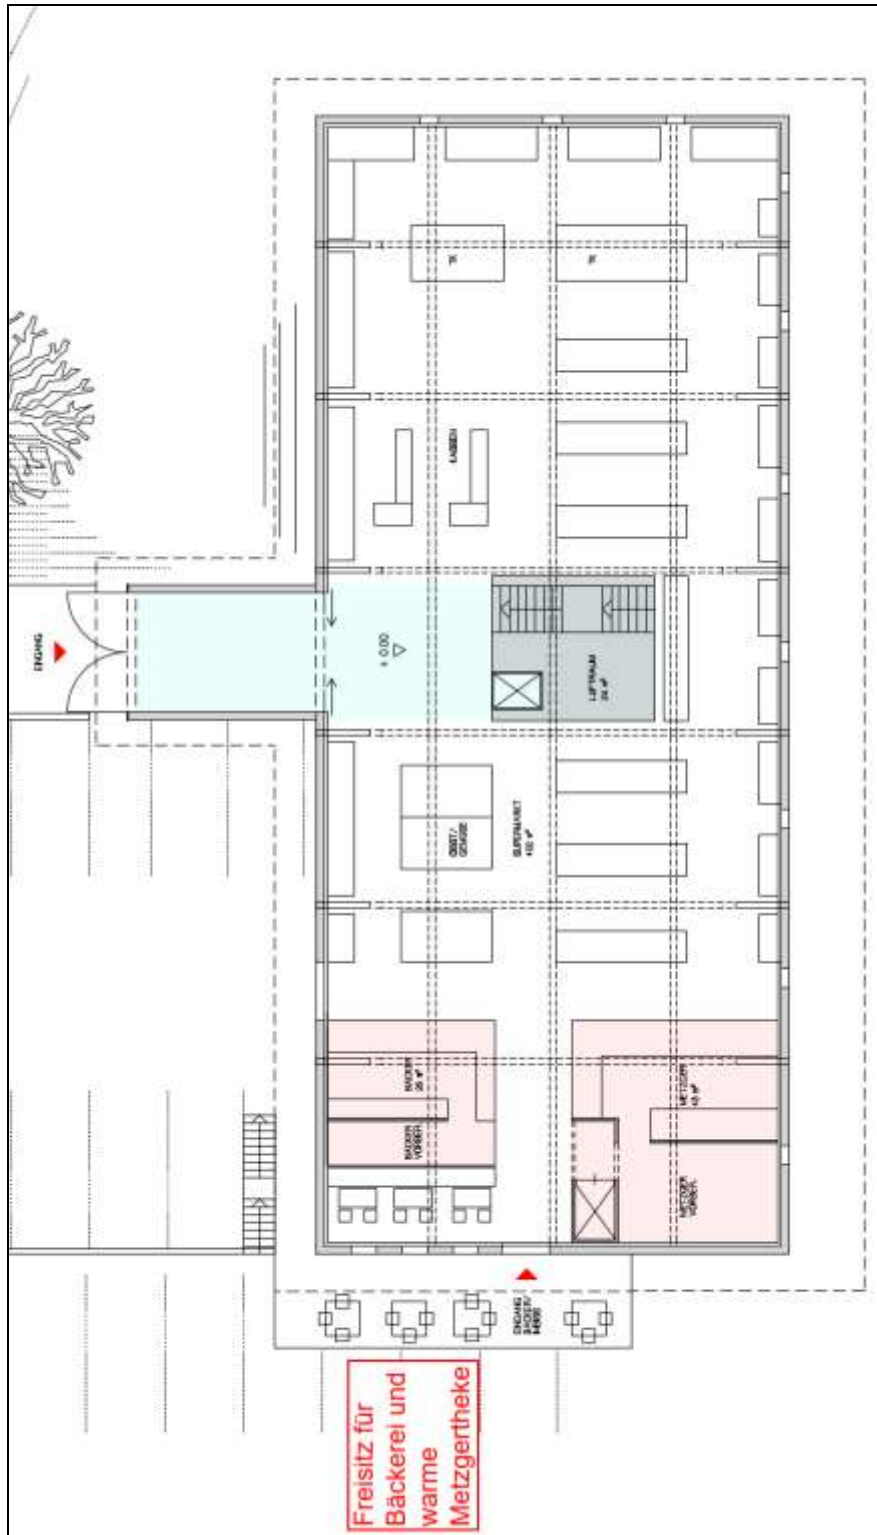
"Schnitzerstadel" - Auszug Grundriss OG gemäß Vorentwurf [a]
